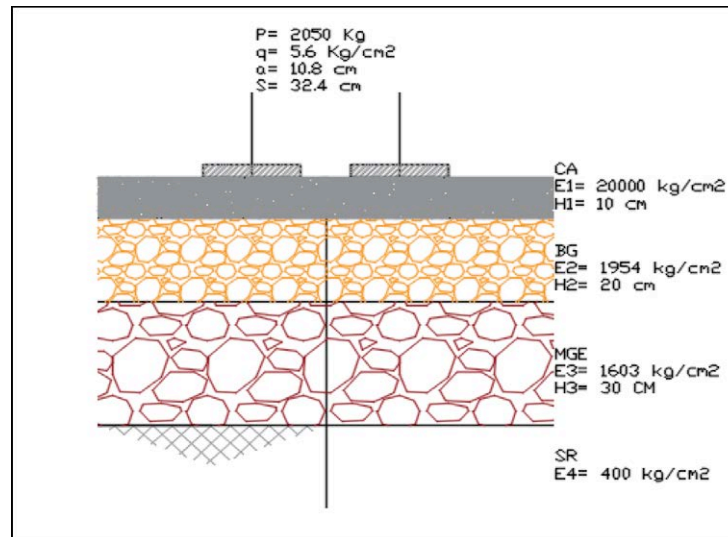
Estructura de pavimento con material granular estabilizado. Fuente. Los Autores
